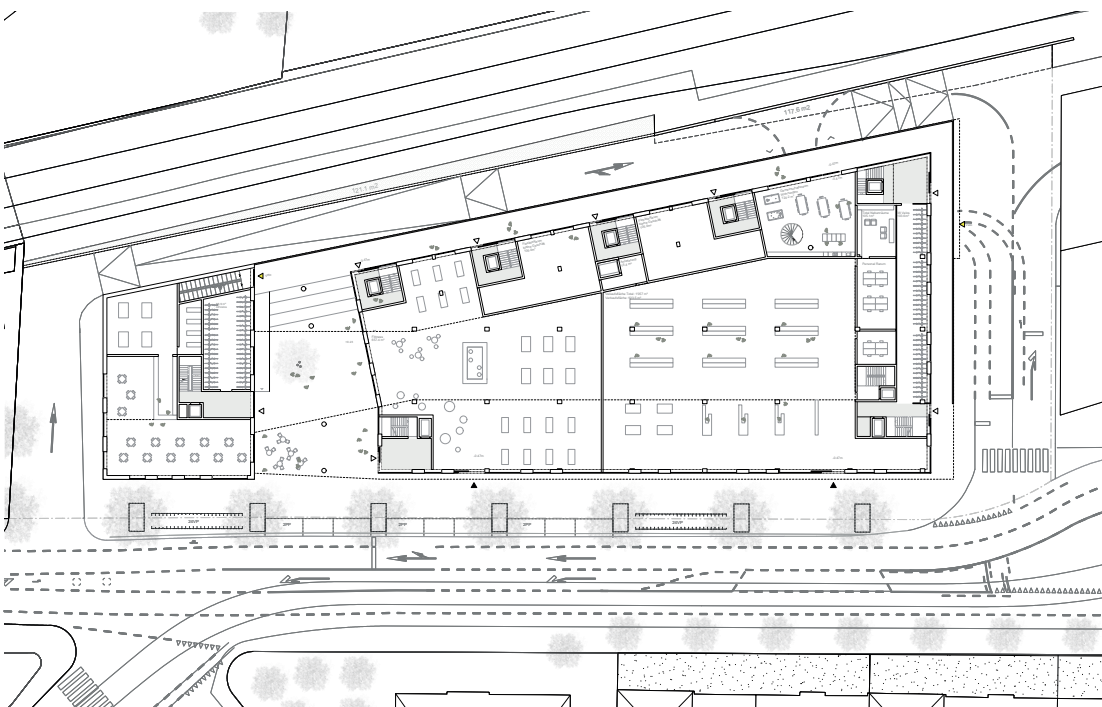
Grundriss Erdgeschoss (Strassenniveau)
